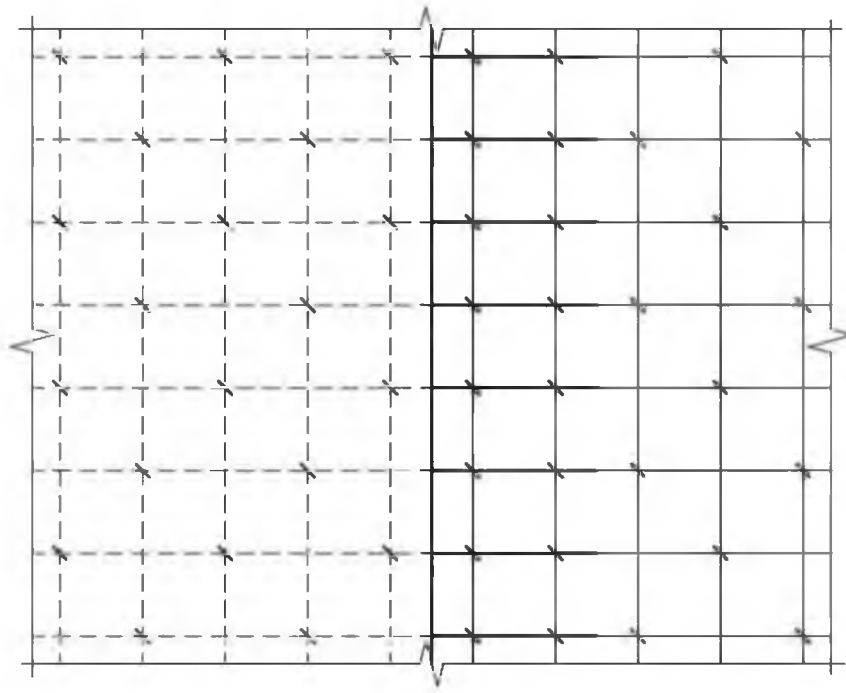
Схема связывания стержней композитной арматуры в сетке и соединение арматурных сеток
